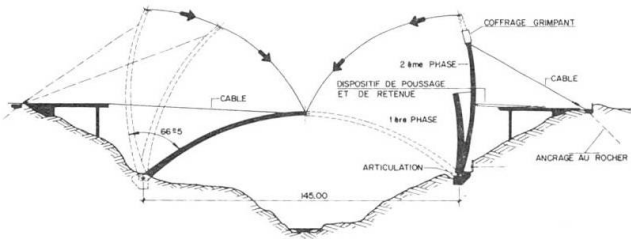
Construction d'un arc par rotation dans un plan vertical
